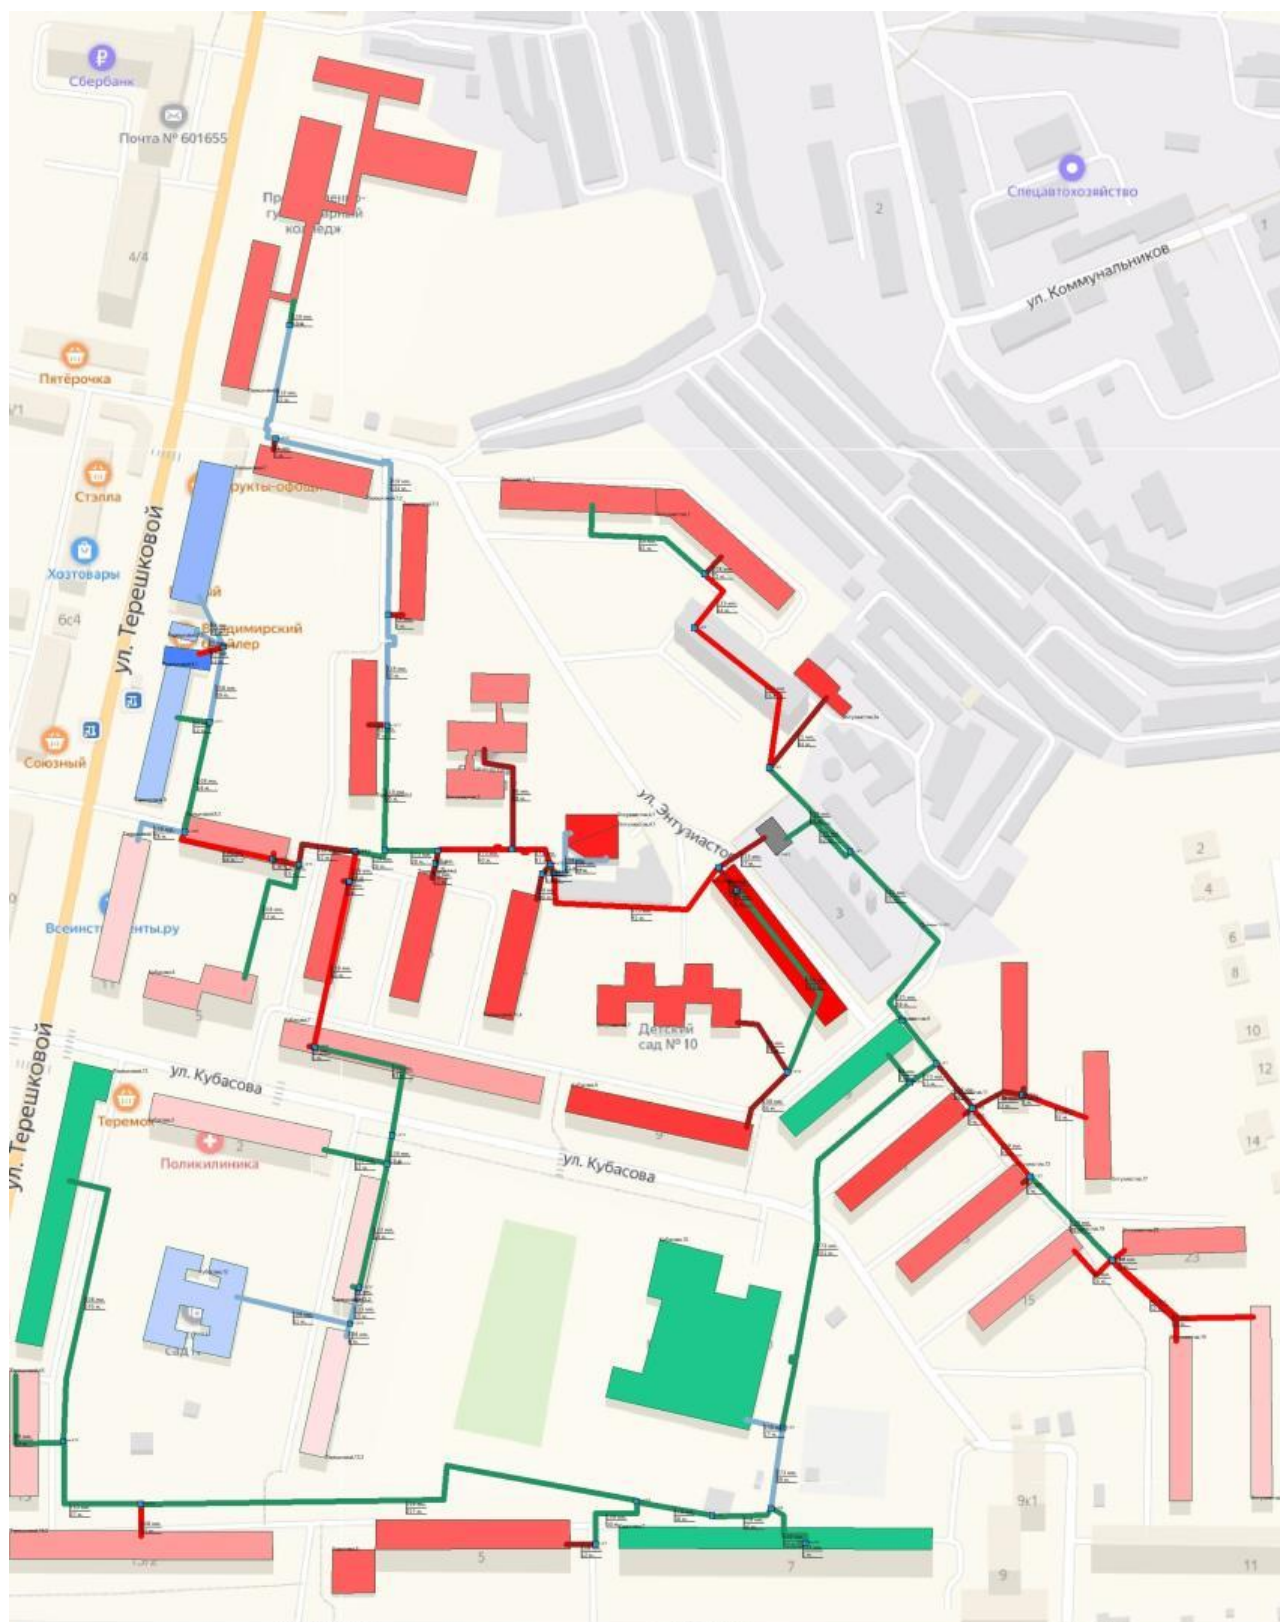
ЦТП от Котельная №8 с переключением нагрузок от котельной №4
